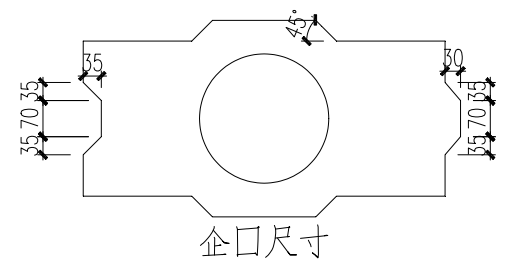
预应力混凝土离心翼边板桩截面配筋图
